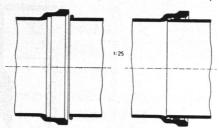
Gußeiserne Heberleitung mit eingewalzten Gummidichtungsringen.
